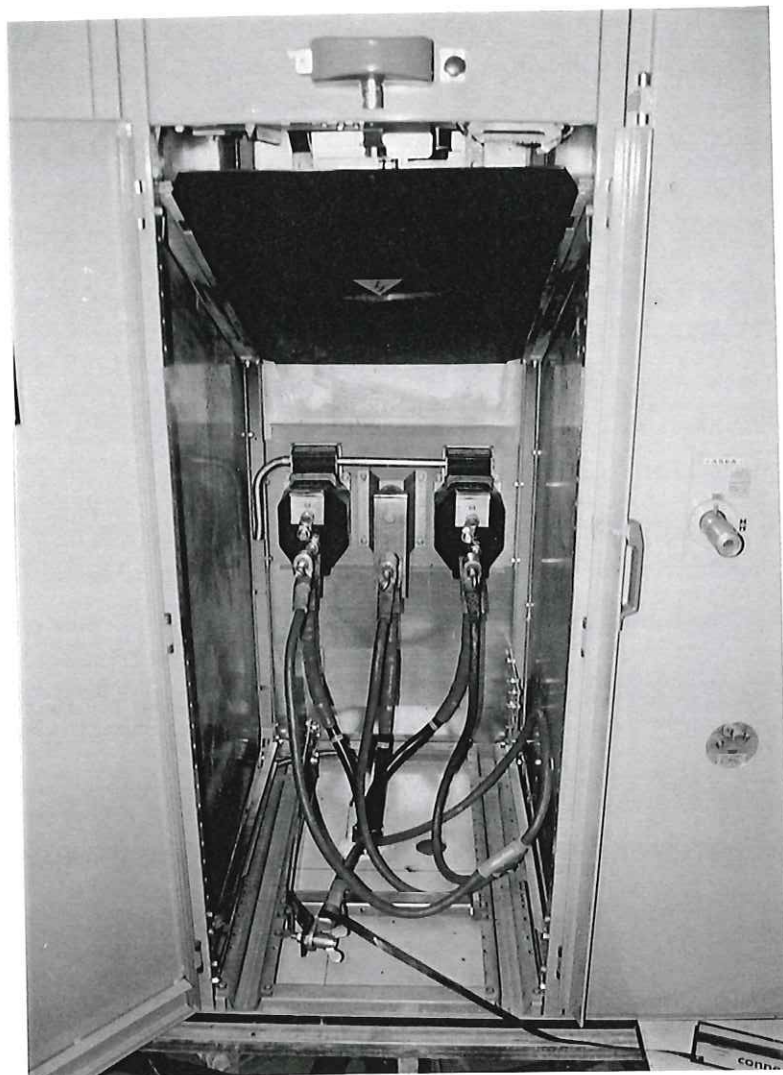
visar facket när detta är iordningställt för arbete. Här är plexiglasskivan på plats som det skall se ut när arbete pågår i facket. Till de nedre hornen är jordningsdon anslutet.
